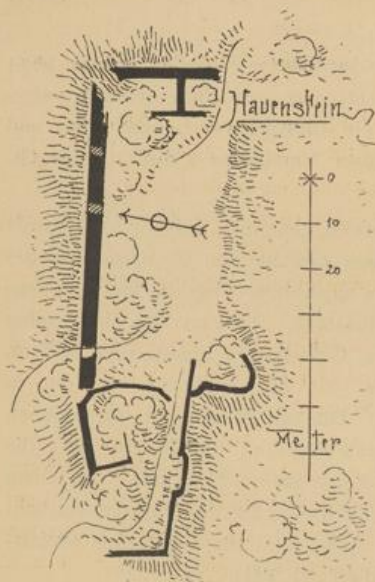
Hauenstein. Grundriss der Burg.
